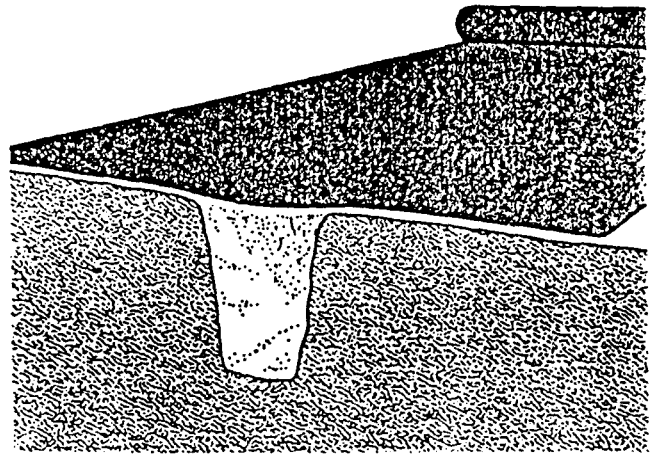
Colocación de geotextil en una zanja de drenaje.
